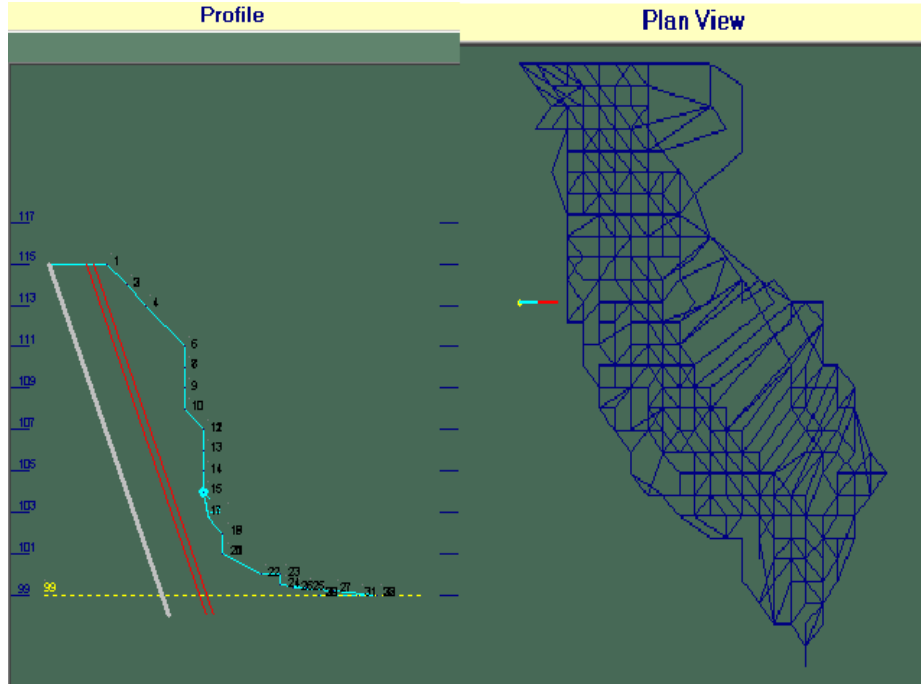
Ömerli sahası delik profili ve plan görünümü (aynanın orta kısmı 7. delik)
